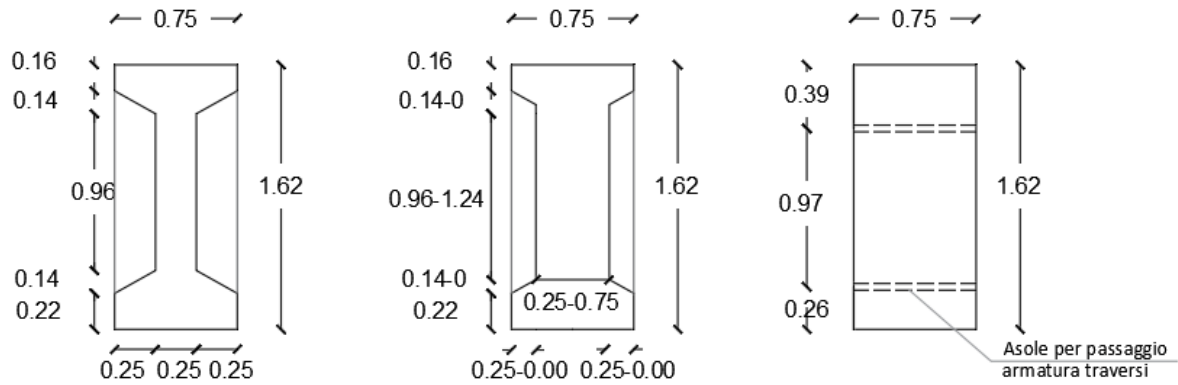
Geometria trave, a) sezione a doppio T, b) sezione variabile all'estremità, c) sezione rettangolare
